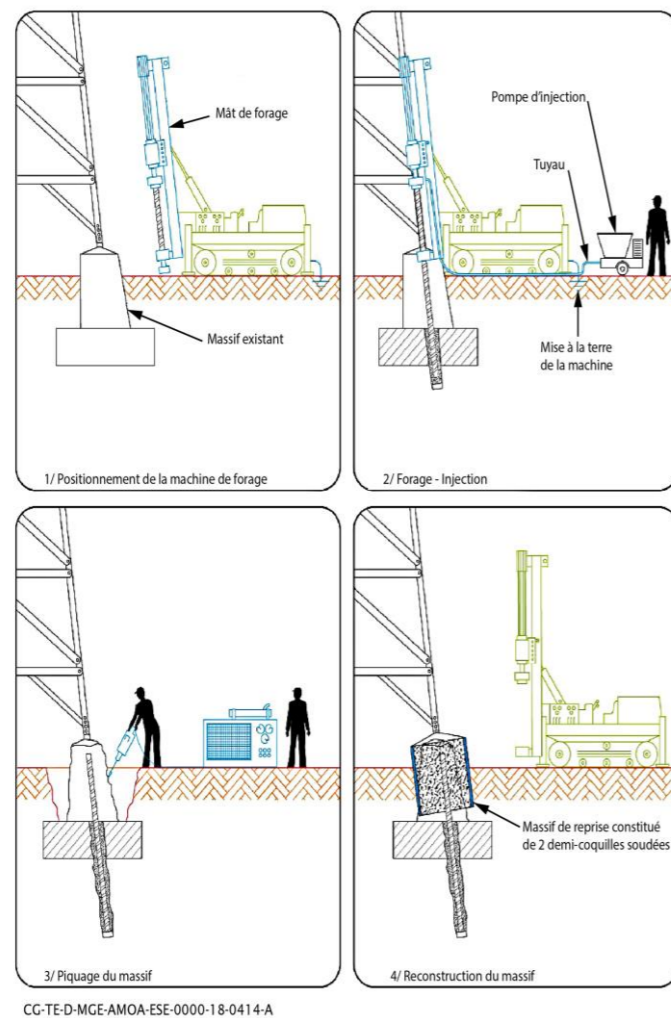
Travaux de renforcement des fondations (source RTE, juin 2020 (17))
